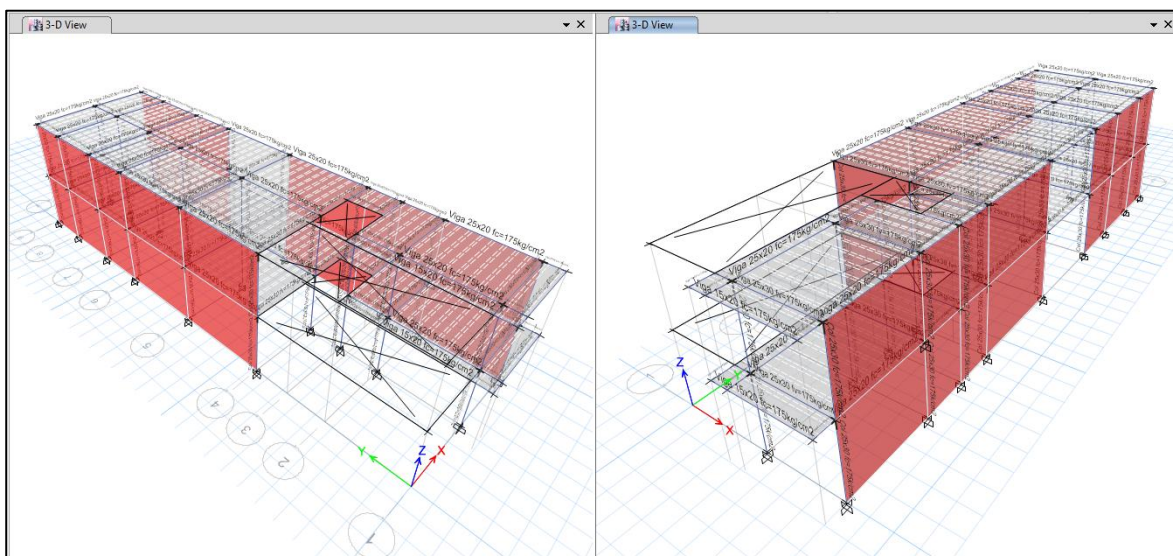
Modelo estructural de la situación actual de la vivienda 2 – Vista en perspectiva. Fuente:
